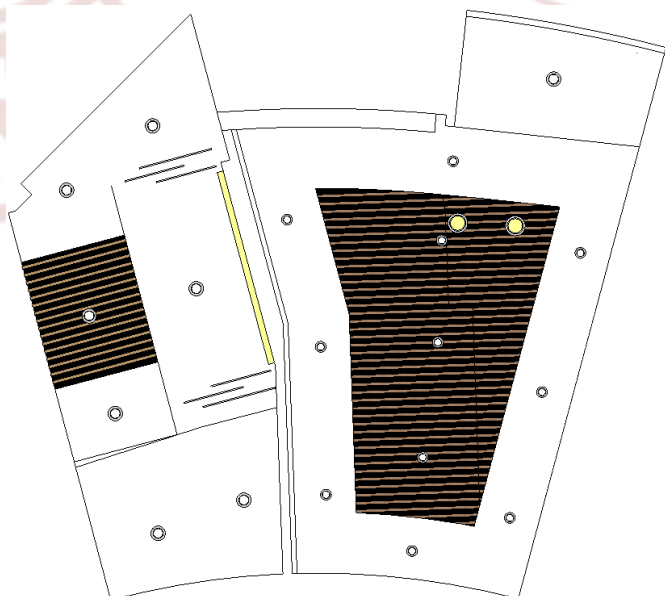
Alternatif 2 Rencana *Ceiling Deluxe Room
